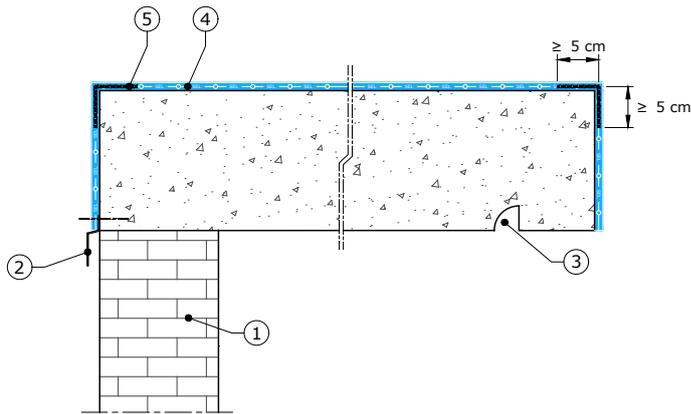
Coupe sur escalier préfabriqué avec mur d'échiffre - Exemple
